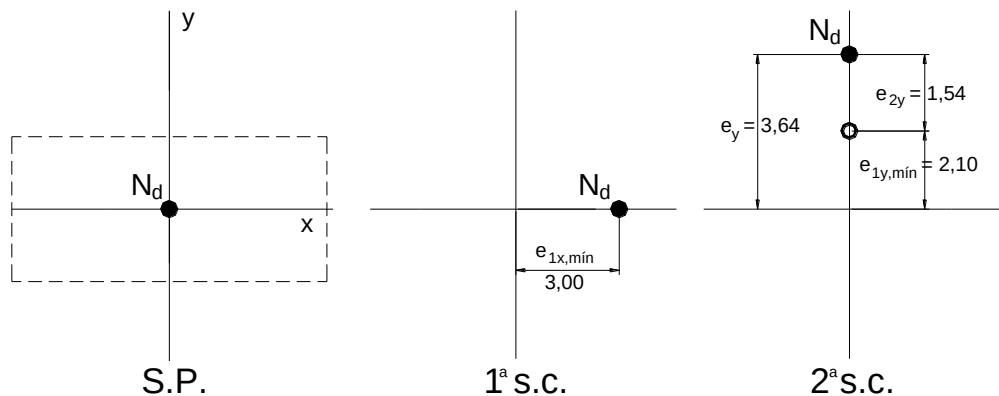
Situação de projeto e situações de cálculo do pilar intermediário.
